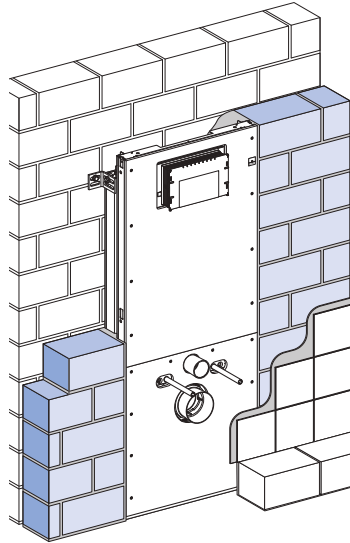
Elemento Geberit Duofix per costruzione in muratura in una parete murata
